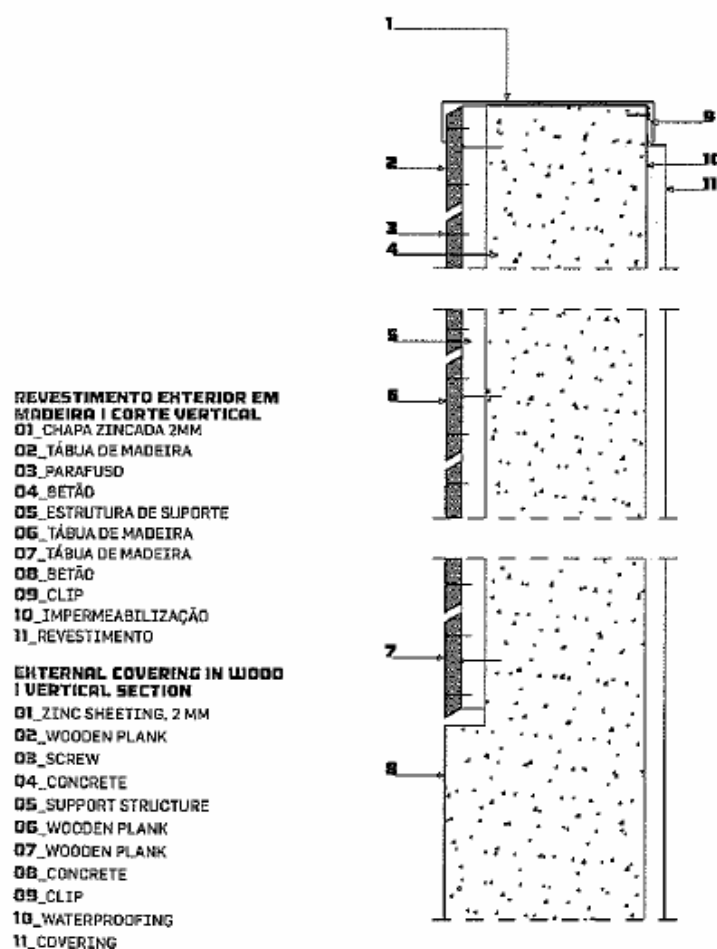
Pormenor construtivo do Revestimento exterior em madeira (Fonte: Arquitectura Iberica Ano III Nº15 Junho 2006 - Sustentabilidade/ Sustainability)
